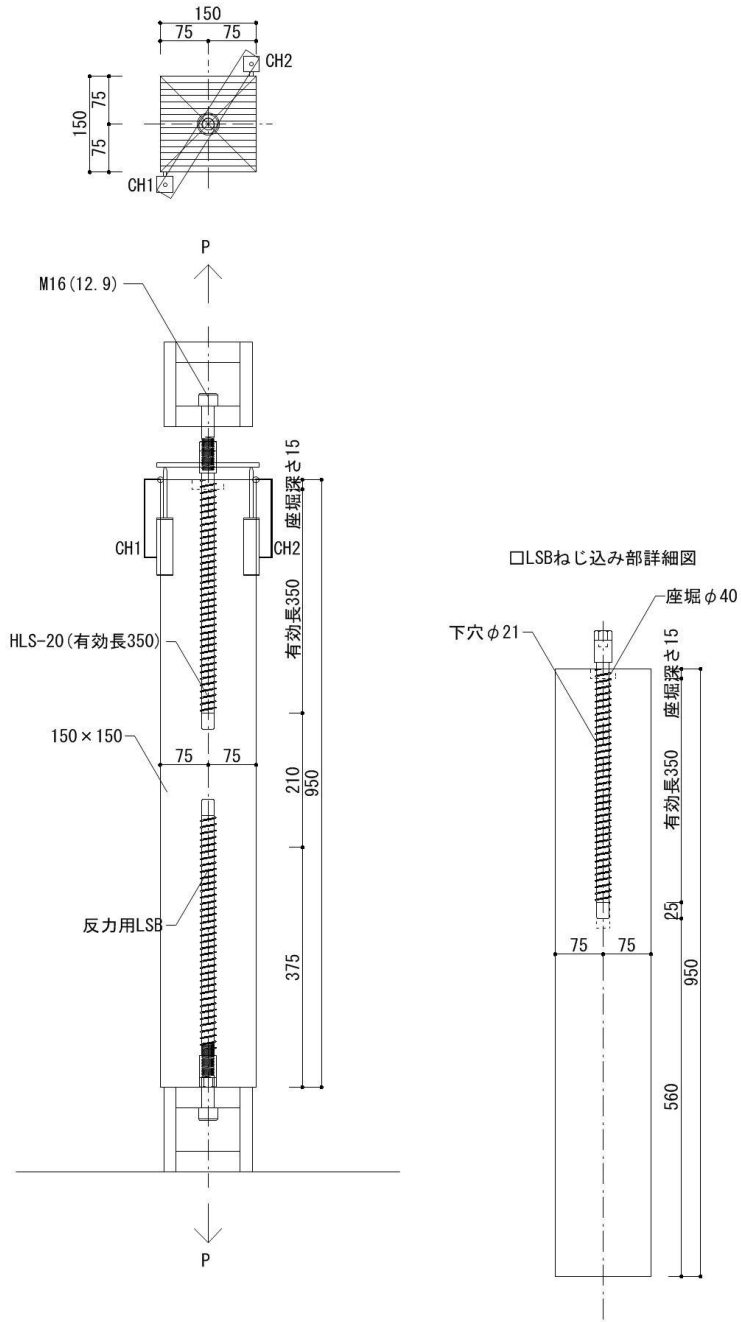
試験体の形状及び寸法 (A-1)
